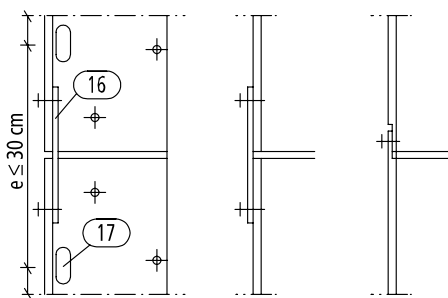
Randwinkelstoß mit Varianten: Grundriss Geh- und Radwegbrücke
